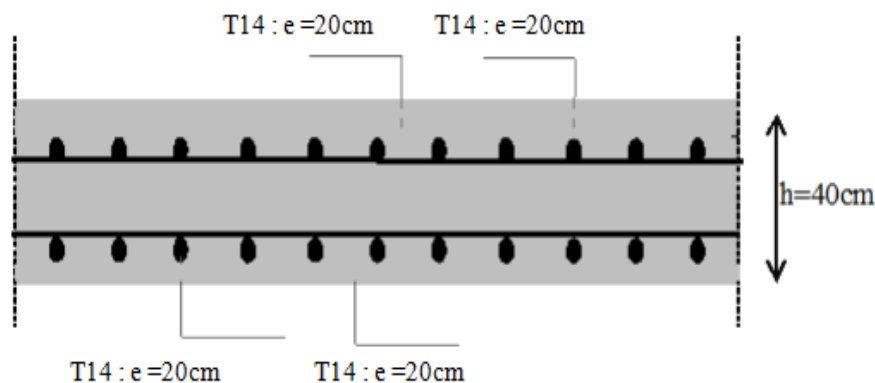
Ferrailage de la dalle du radier sens y-y.
